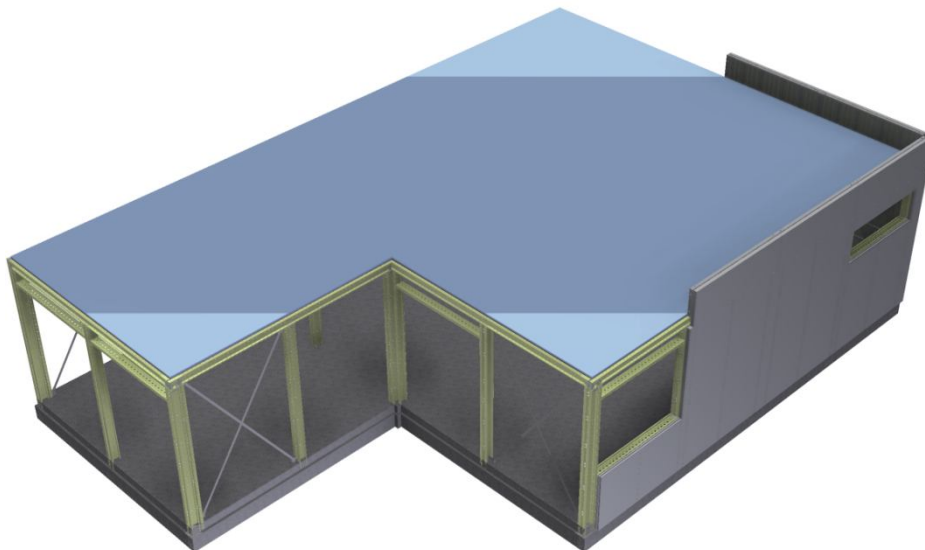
Aplicação de paredes, platibandas e padiais na estrutura Modiko
